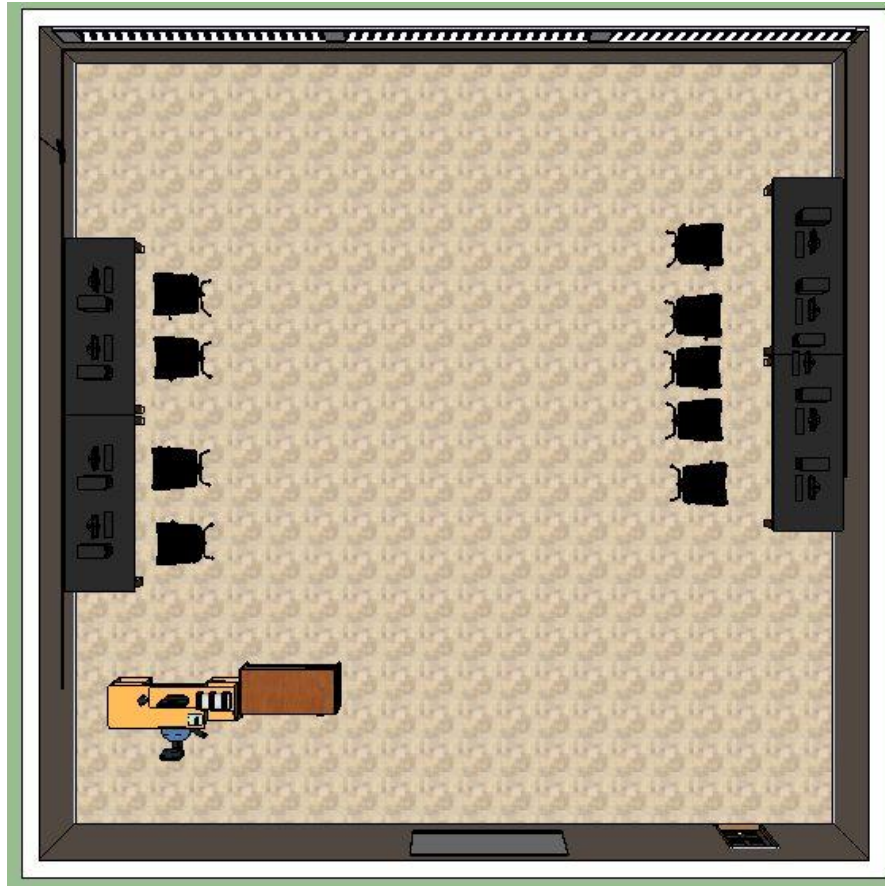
D: Vista en planta del Laboratorio de Hardware
